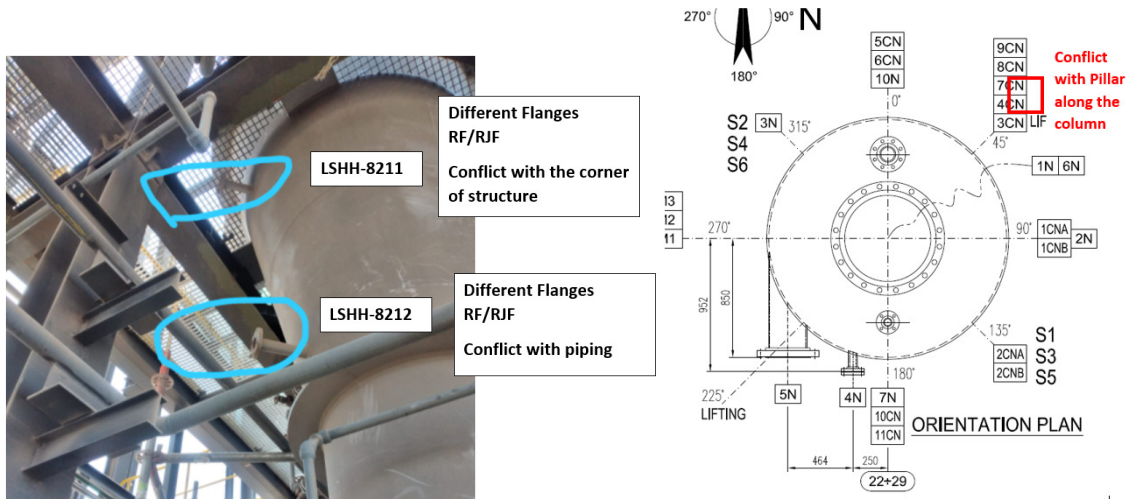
Posição dos sensores junto ao pilar da estrutura.
